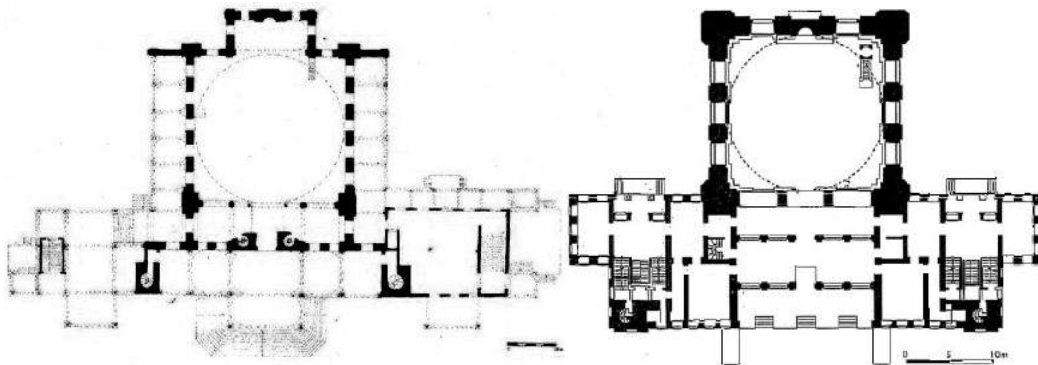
Üsküdar Ayazma Cami planı (URL 24) Şekil 35. Beylerbeyi Cami planı (URL 24)
